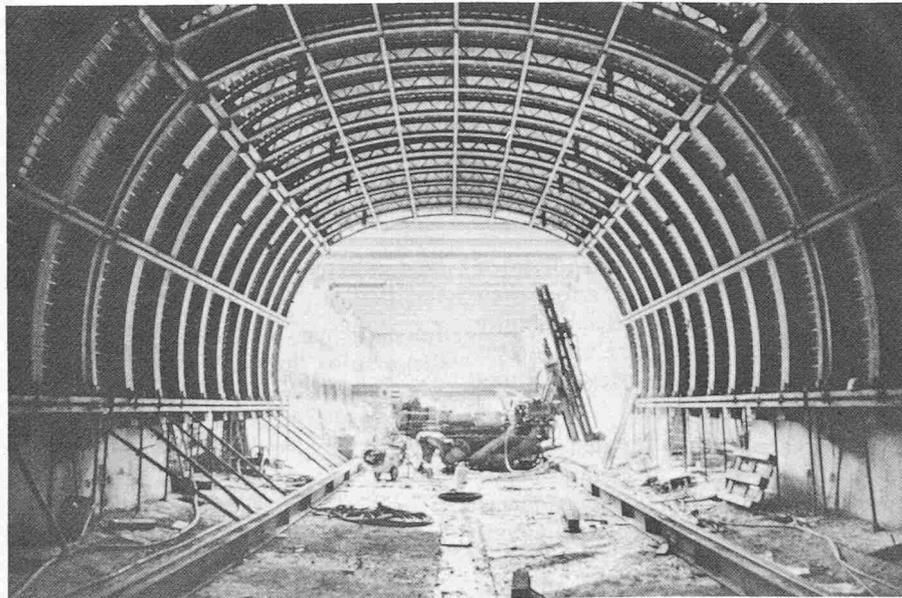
Los Süd: Gewölbeschaltung und Baugrube
